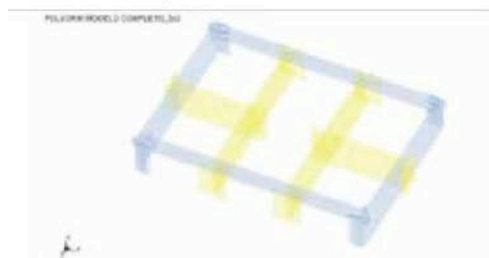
Armaduras Ø32 mm de muros interiores y muros perimetrales
